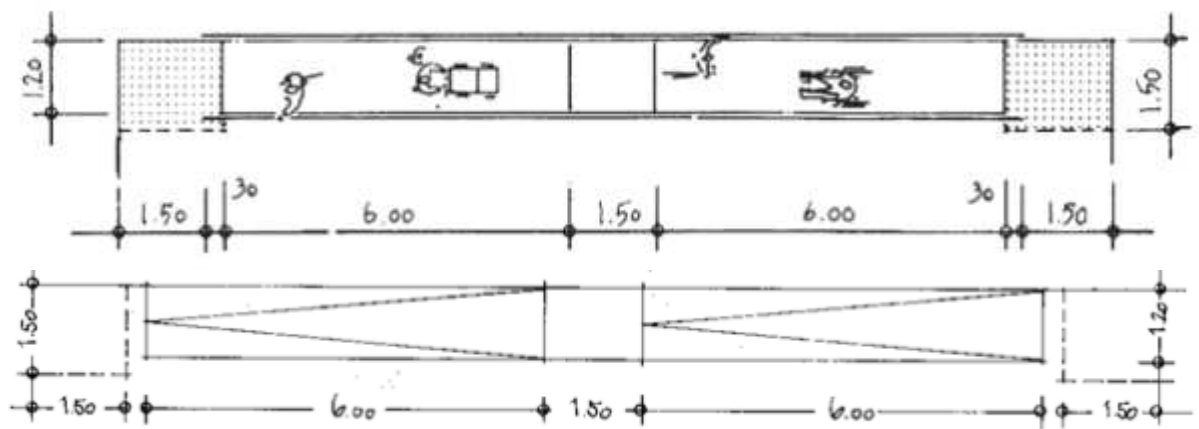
Rampe in Draufsicht und Grundriss
